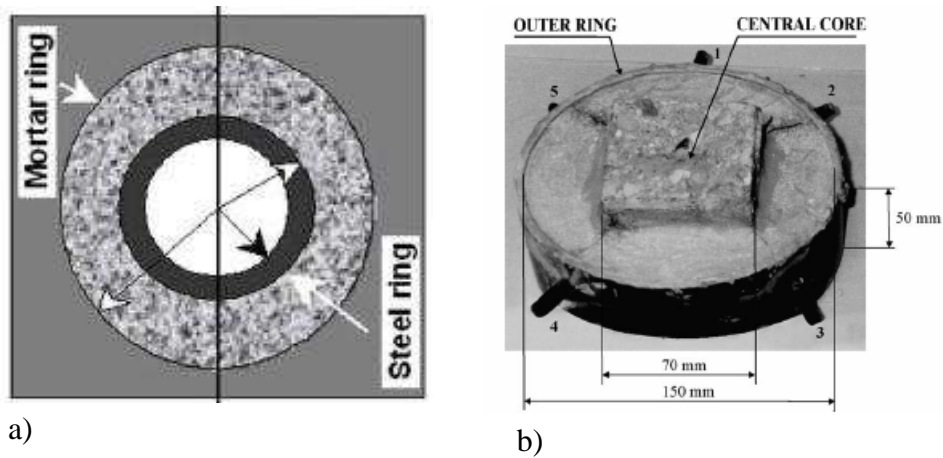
Anneau de fissuration aux jeunes âges.
